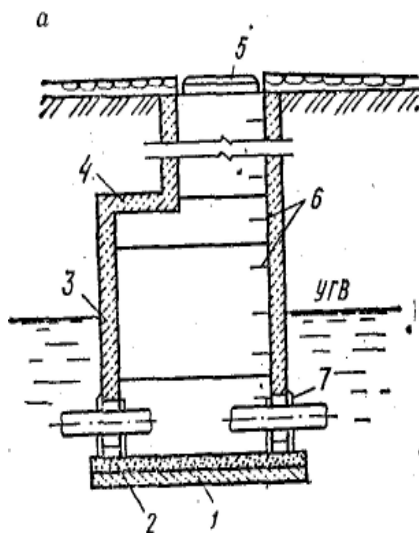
Збірний круглий залізобетонний колодезь, що влаштовується у водонасичених ґрунтах: 1 – бетонна підготовка; 2 – плита днища з асфальтовим покриттям; 3 – залізобетонні кільця; 4 – плита перекриття; 5 – чавунний люк з кришкою; 6 – скоби; 7 – гідроізоляційне покриття;
